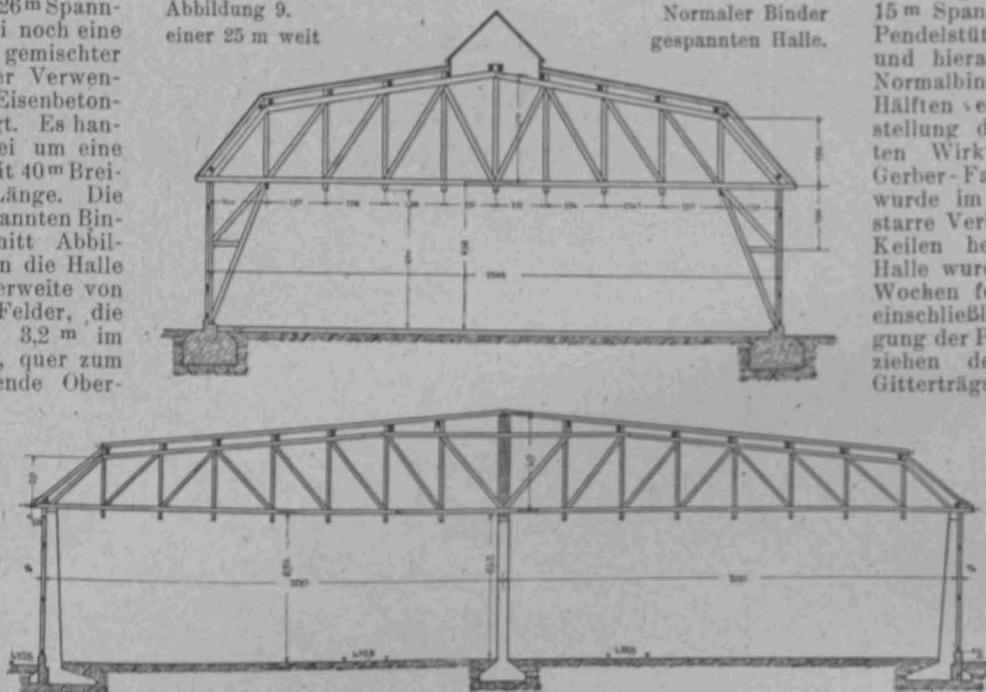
Querschnitt durch eine Arbeitshalle von 40 m Weite. Holzbinder nach Bauweise „Kübler“ auf Eisenbetonstützen. (Maßstab 1:333.)
